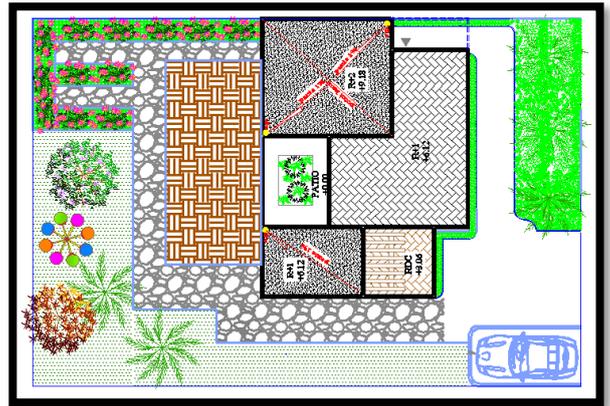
plan de toiture d'une maison individuelle. Source : auteurs.
